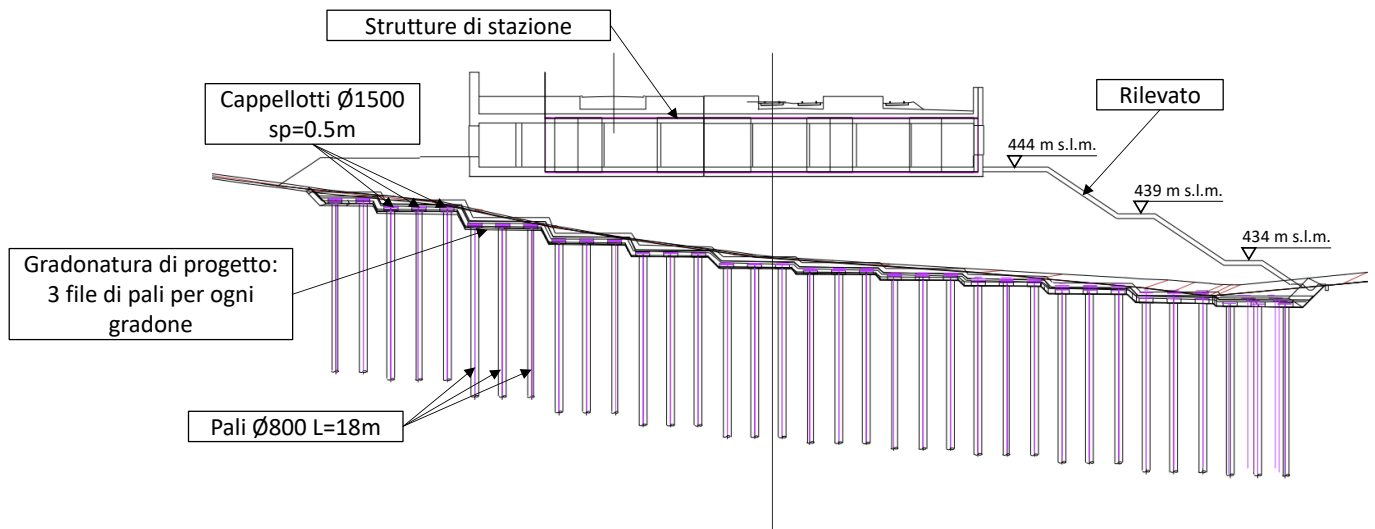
Sezione 11. Sovrapposizione tra sezione di progetto e porzione di geometria implementata nel modello
